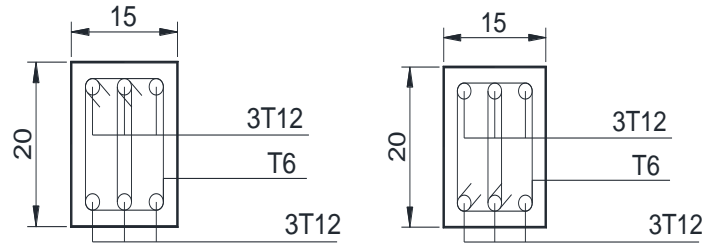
Coupe longitudinale d'une poutre noyée secondaire 15x20cm (plan légèrement irrégulier)
